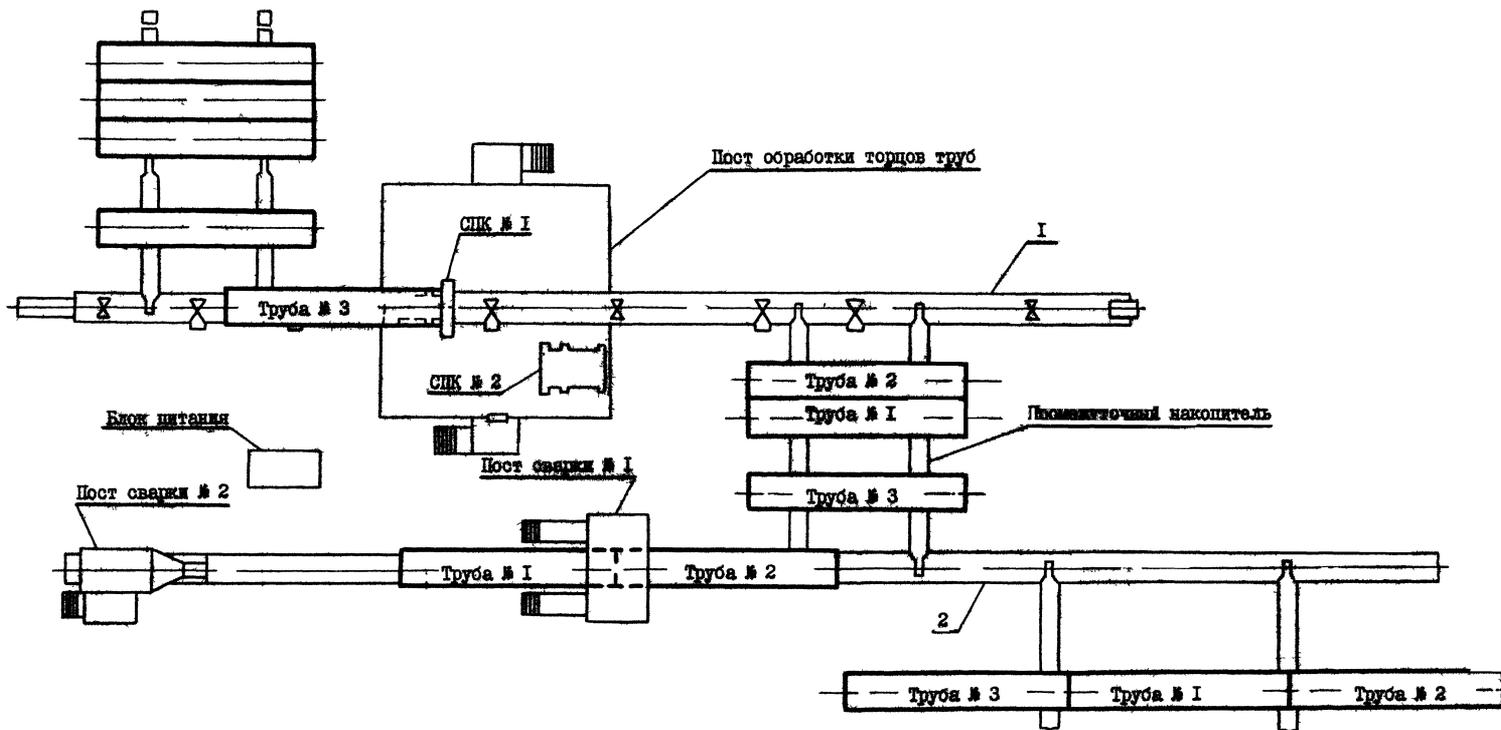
Схема производства работ по сборке и сварке труб в трехтрубные секции на механизированной трубосварочной базе НТС-142В
